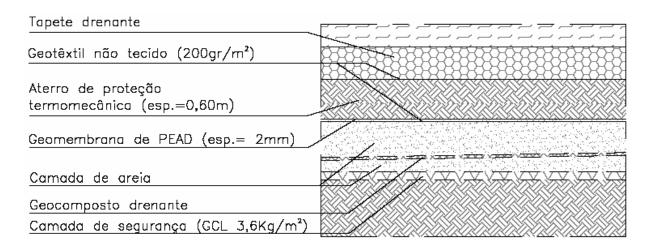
Sistema de impermeabilização de base (liner) para o Aterro Sanitário de Piracicaba-SP.
